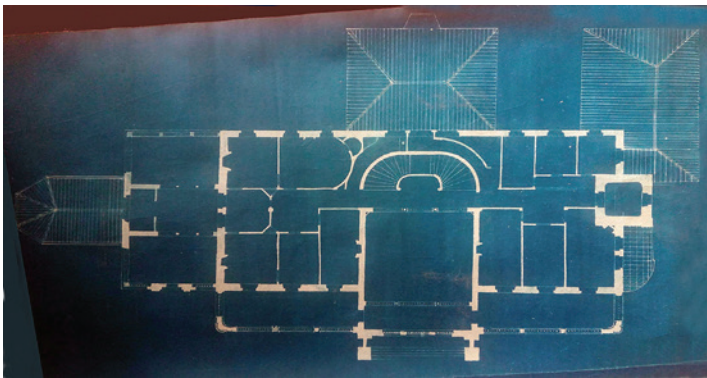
Plano de la planta alta del proyecto "neomudéjar", sin fecha ni firma (Archivo Fundación González Byass Jerez).
